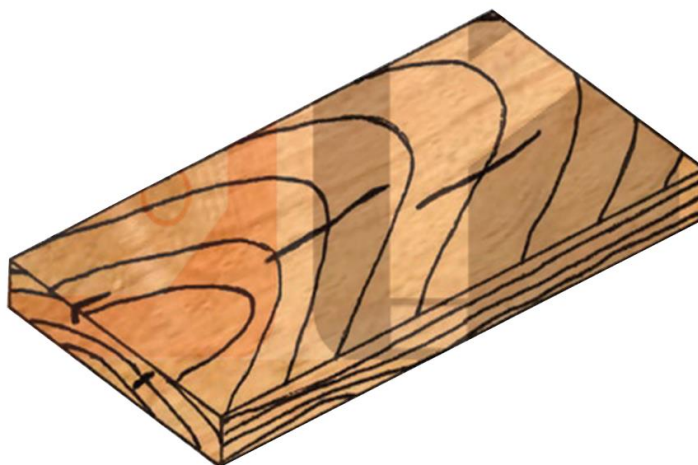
Grietas, Manual de construcción de vivienda de madera, 2014.
